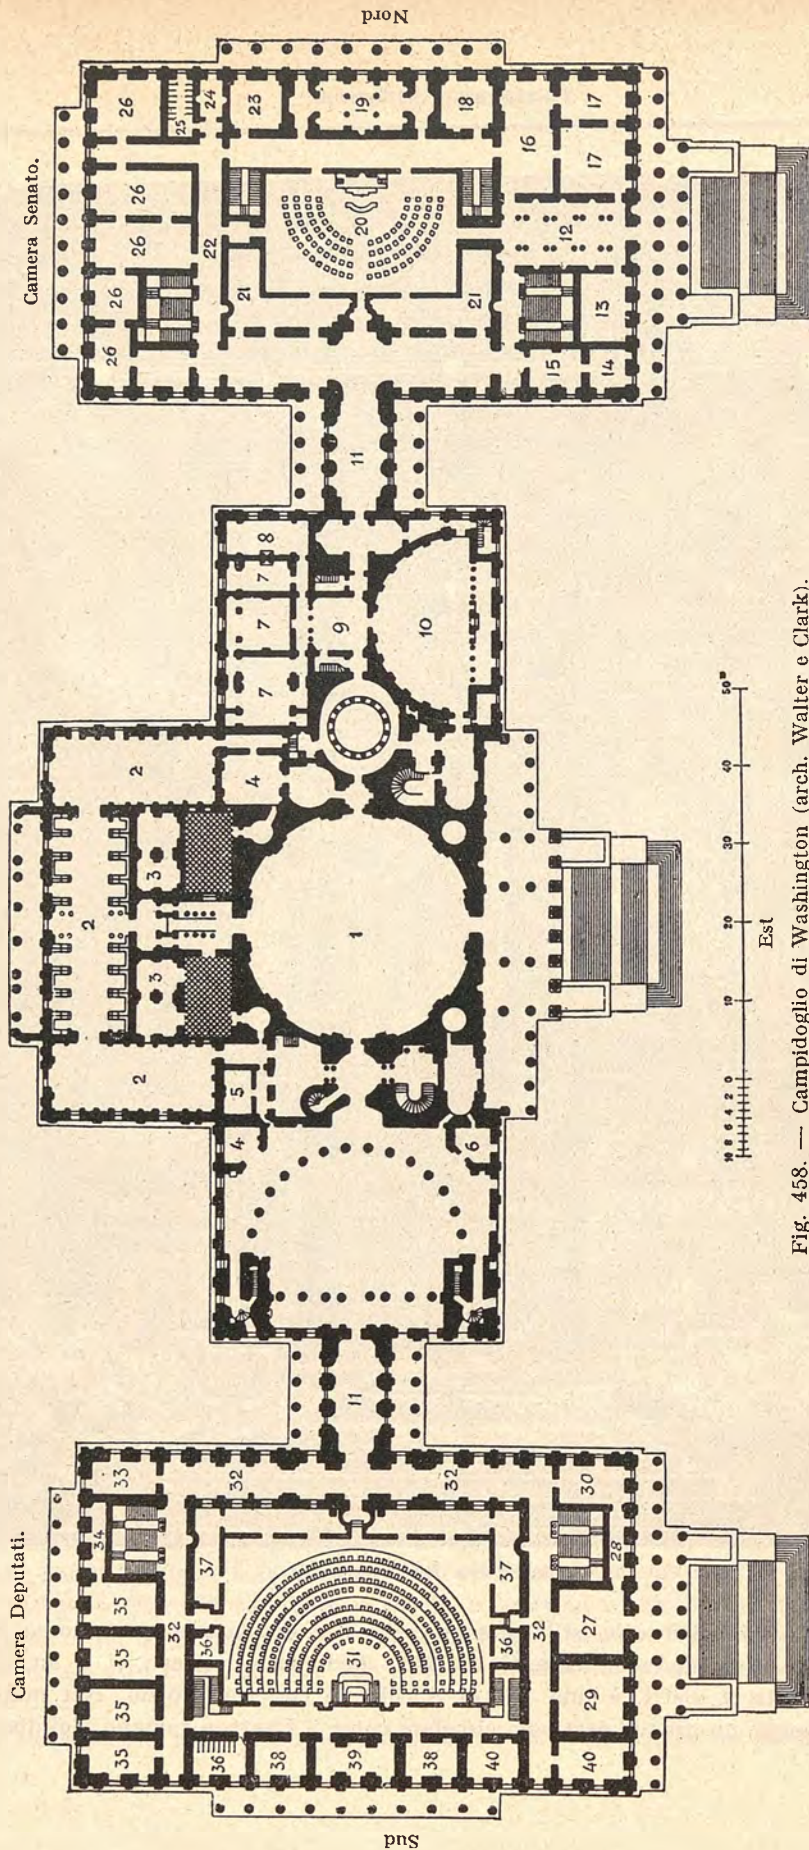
Campidoglio di Washington (arch. Walter e Clark).
